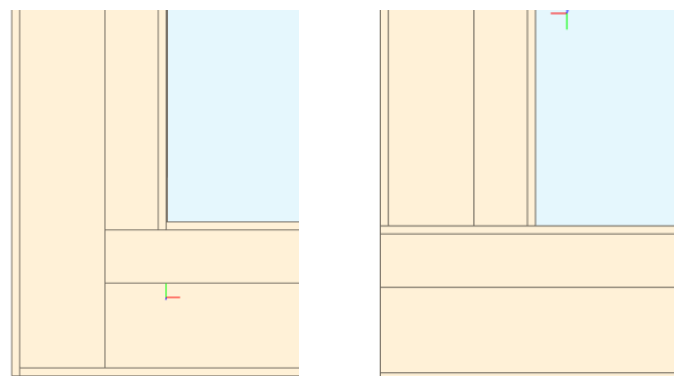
Detaillierte (Links) und nicht detaillierte (Rechts) Ecke Massivholzwand in *BIMvision
